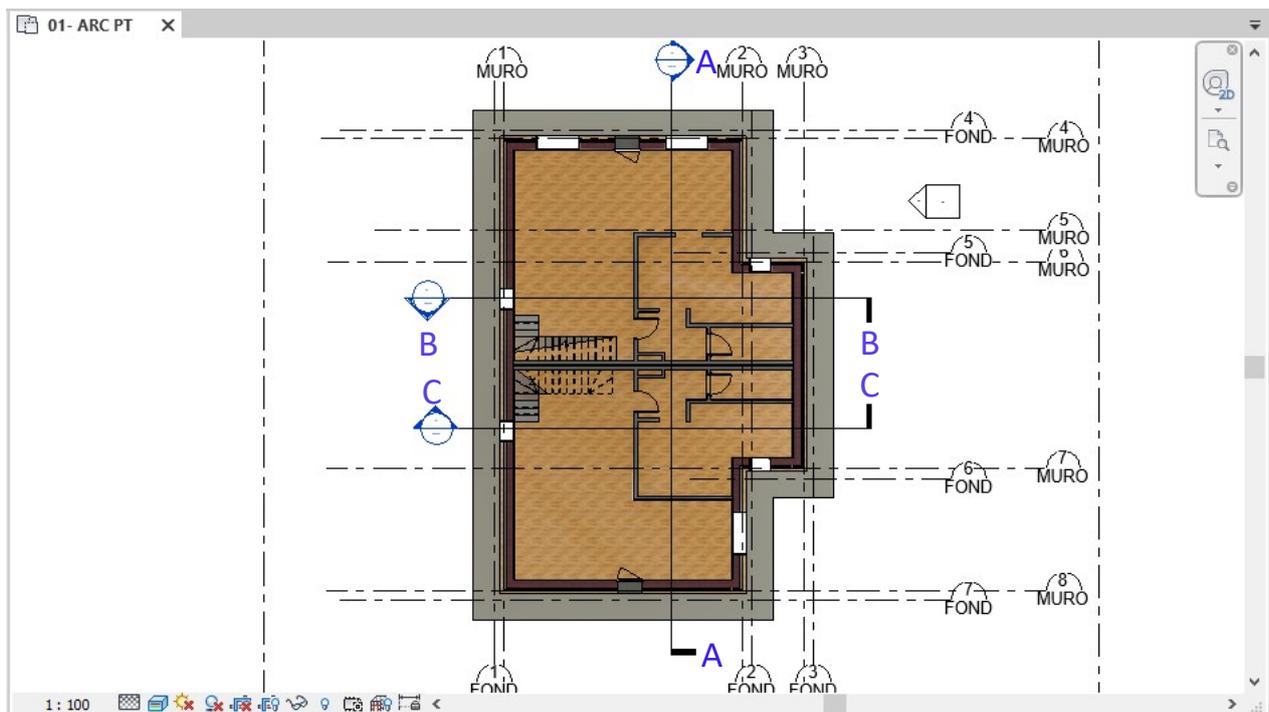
Vista pianta 01-ARC PT: Pianta pavimento piano terra modello architettonico
